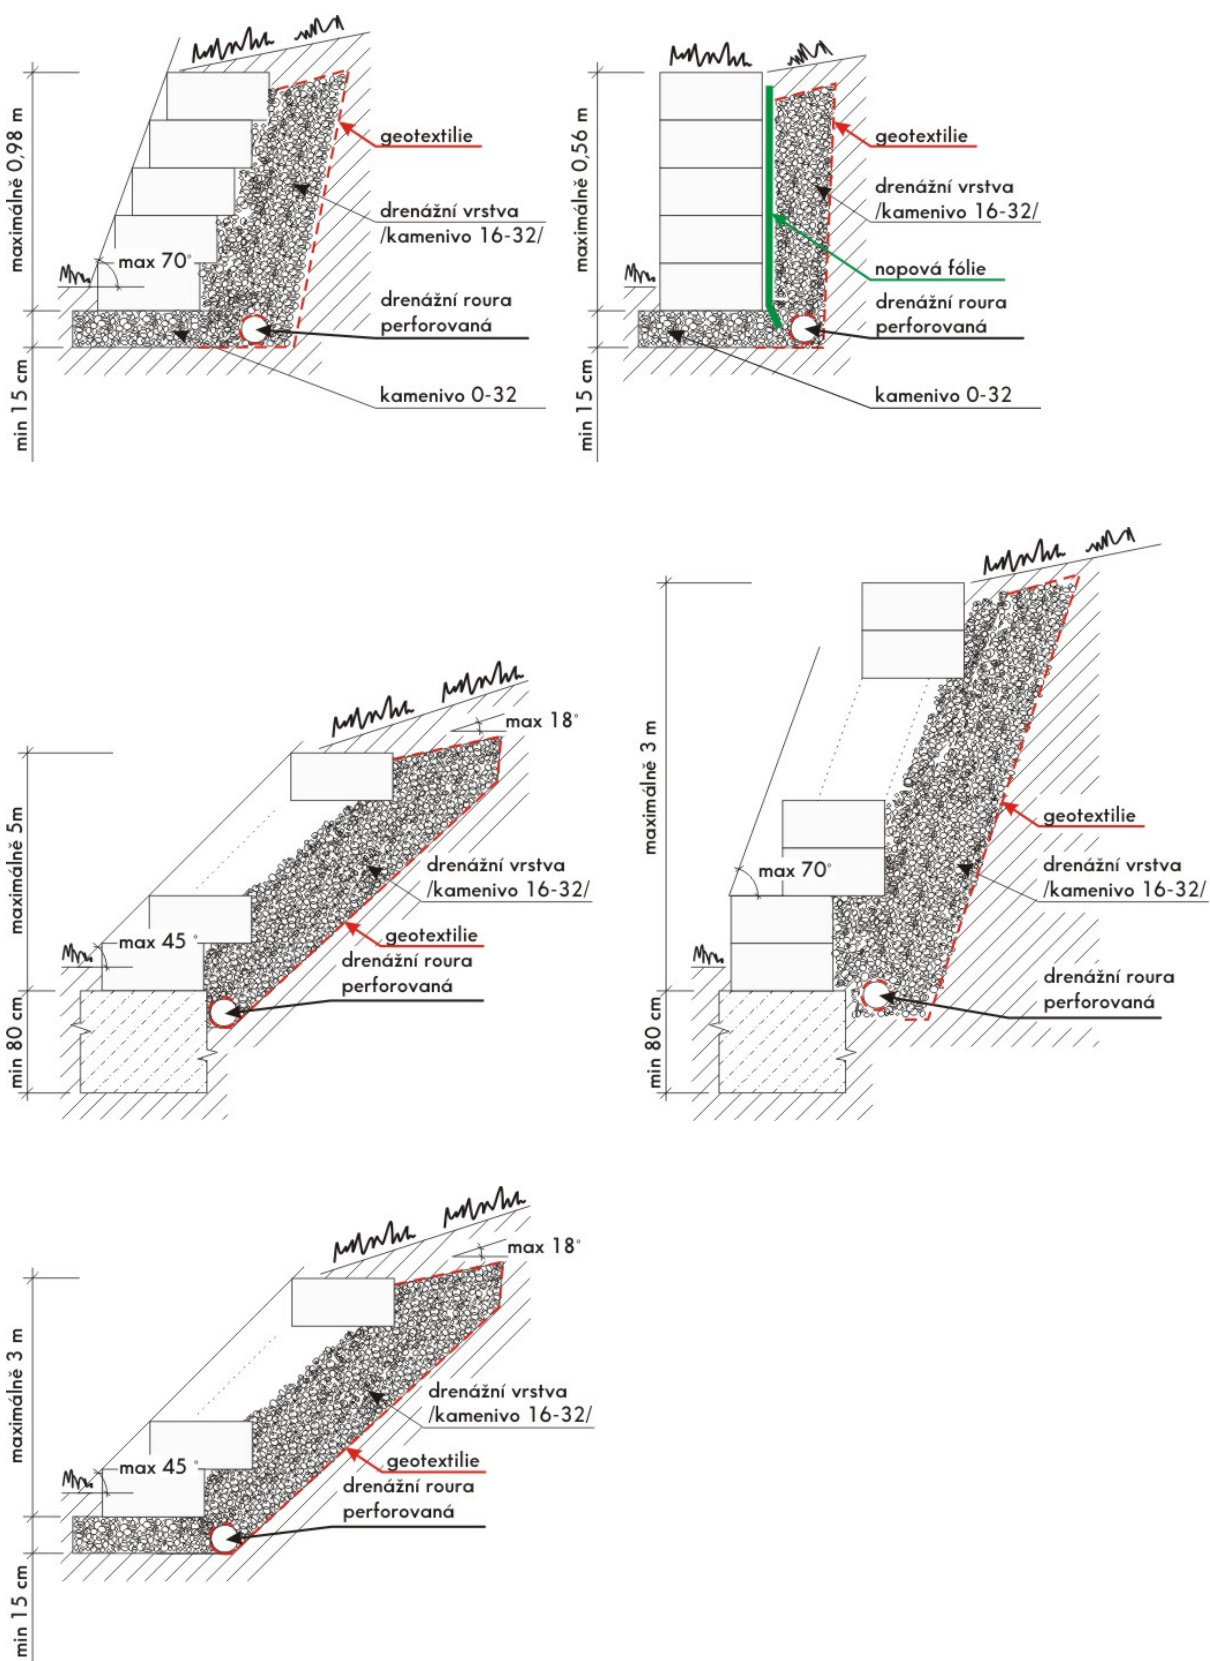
Kladení betonových tvarovek ve dvou řadách za sebou
